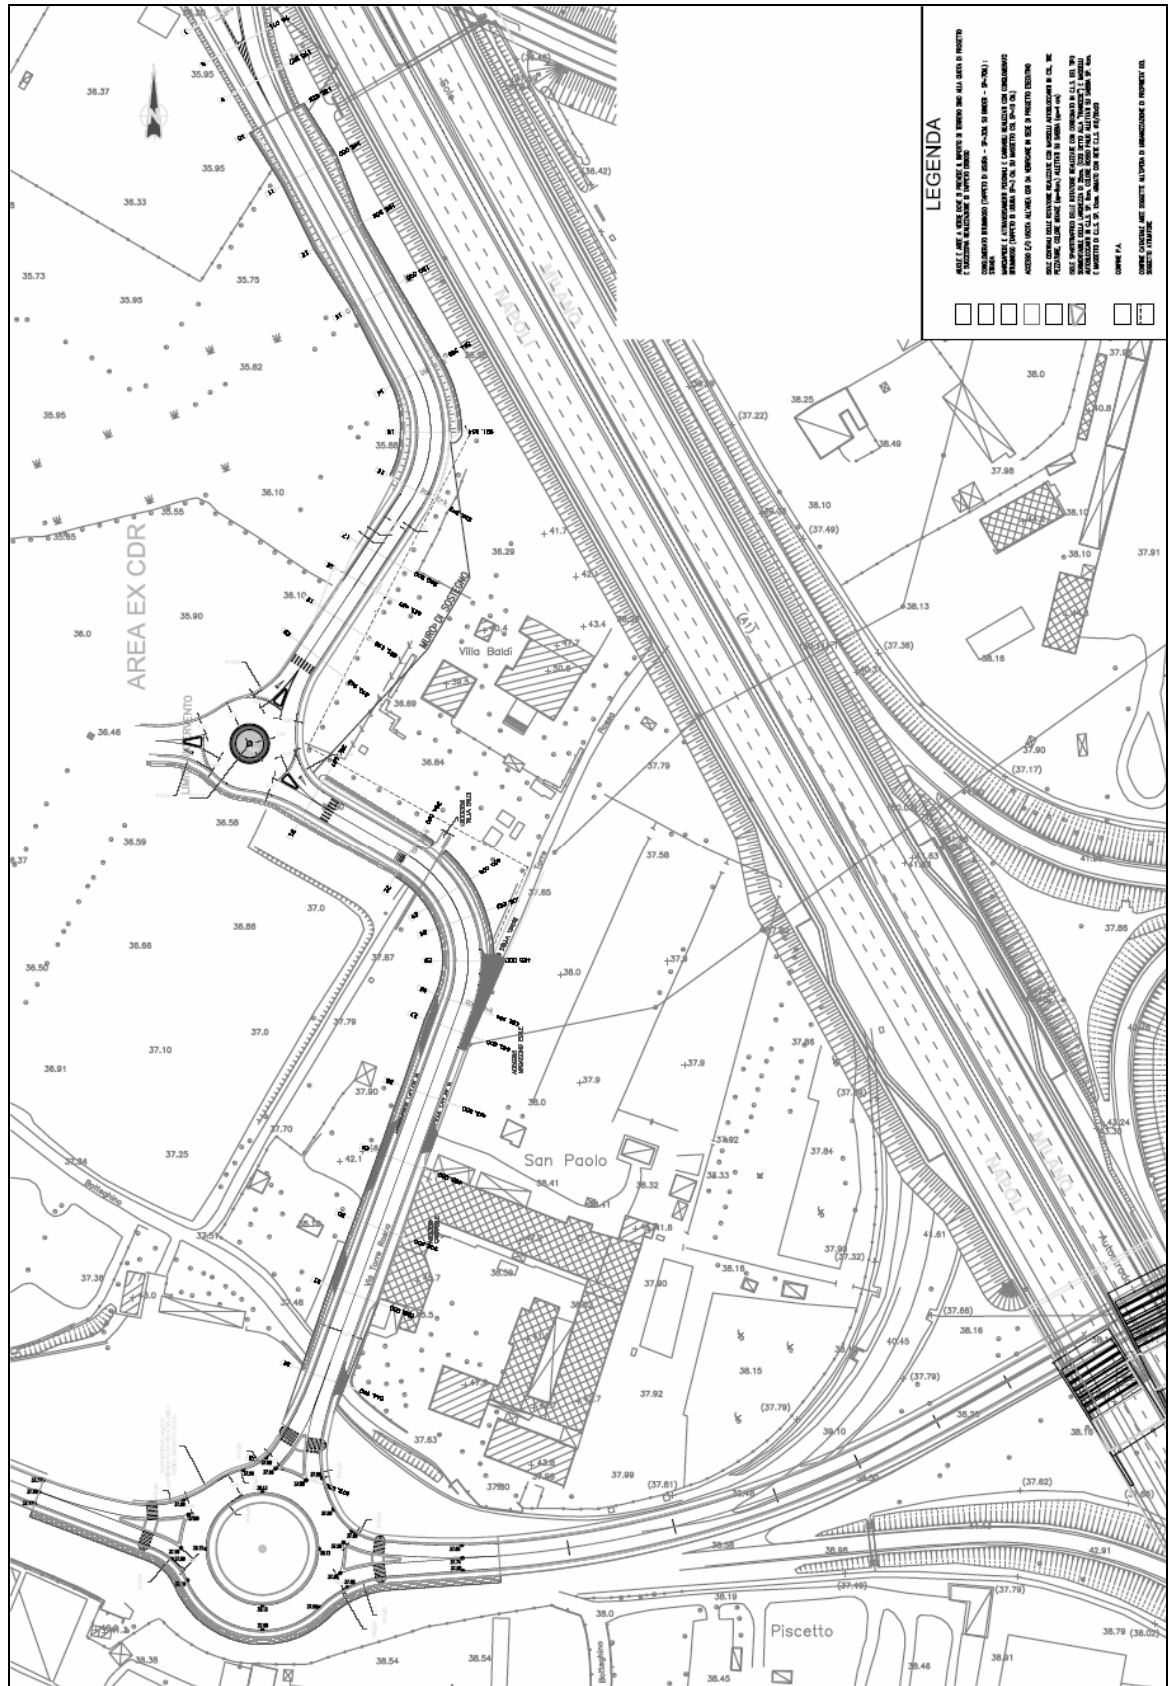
Planimetria del progetto esecutivo della nuova strada complanare all'A1 sul lato est dell'area ex CDR, con la nuova rotonda all'intersezione con Via del Botteghino e sottovia dell'A1 in direzione di Via Pacini.
